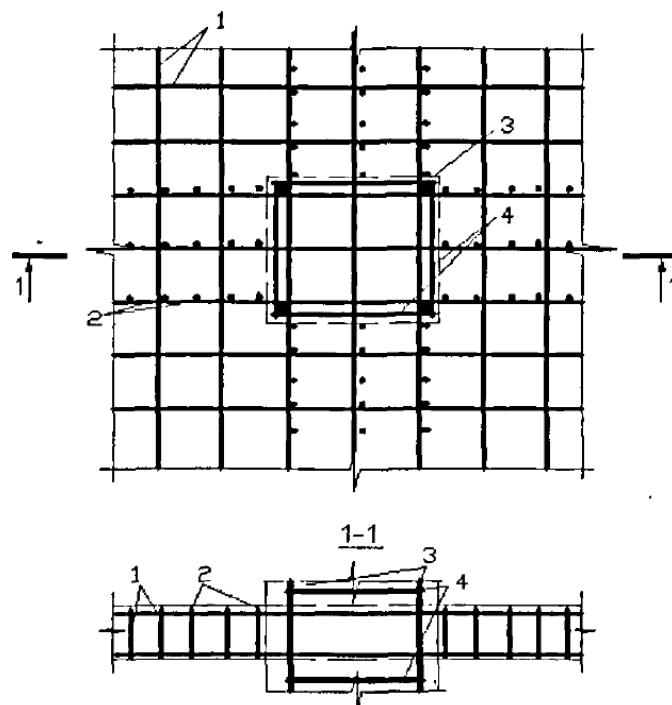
Узел сопряжения безбалочной плиты монолитного перекрытия с колонной без капители [2]: 1 – продольная стержневая арматура; 2 – поперечная стержневая арматура; 3 – продольная арматура колонны; 4 – поперечная арматура колонны
